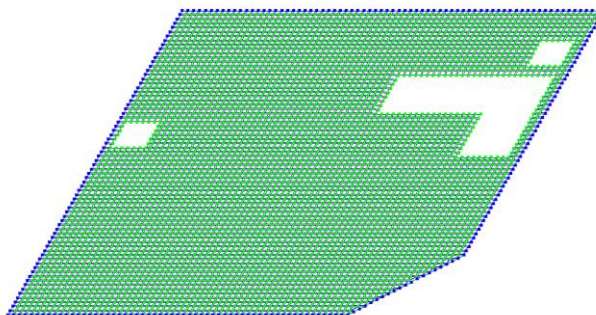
Розрахункова схема плити перекриття 5 поверху в осях Б-В, 18-20
